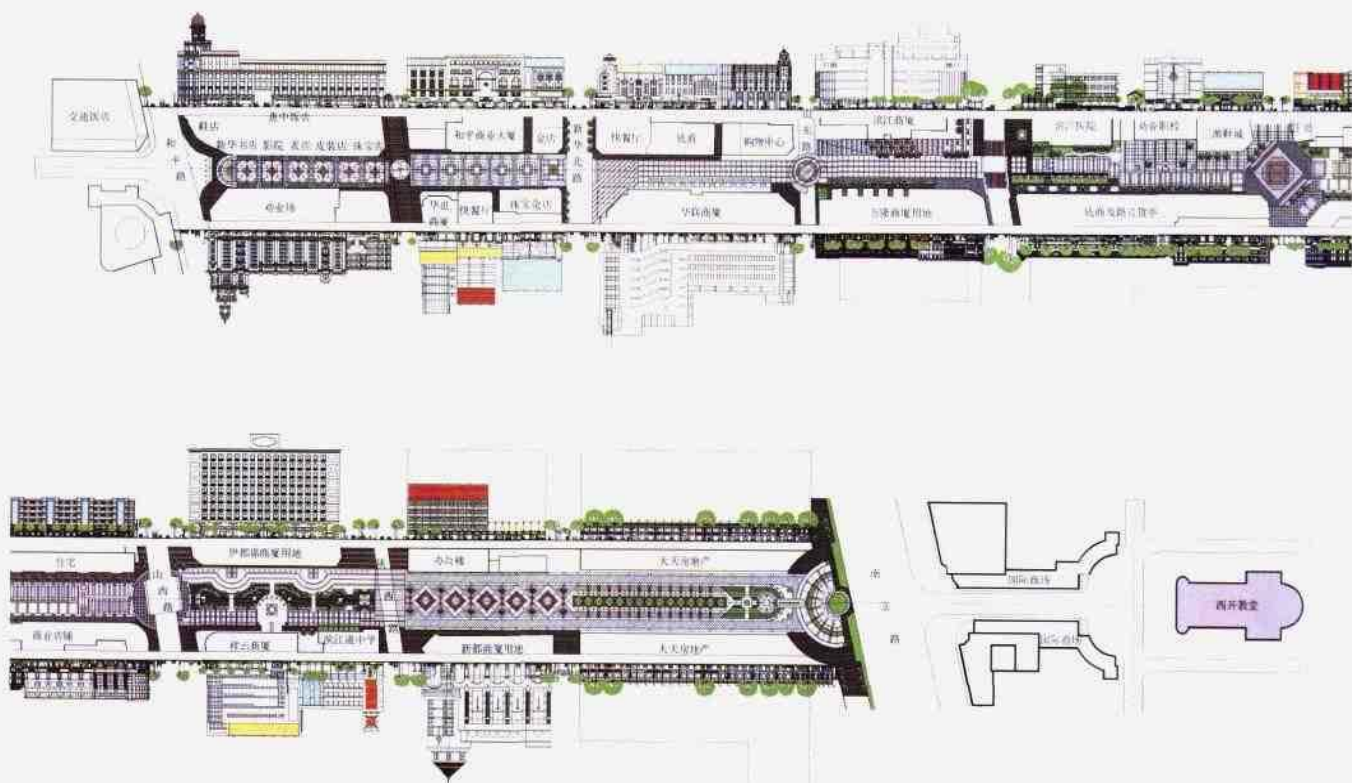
滨江道整治规划平面及沿街立面图
